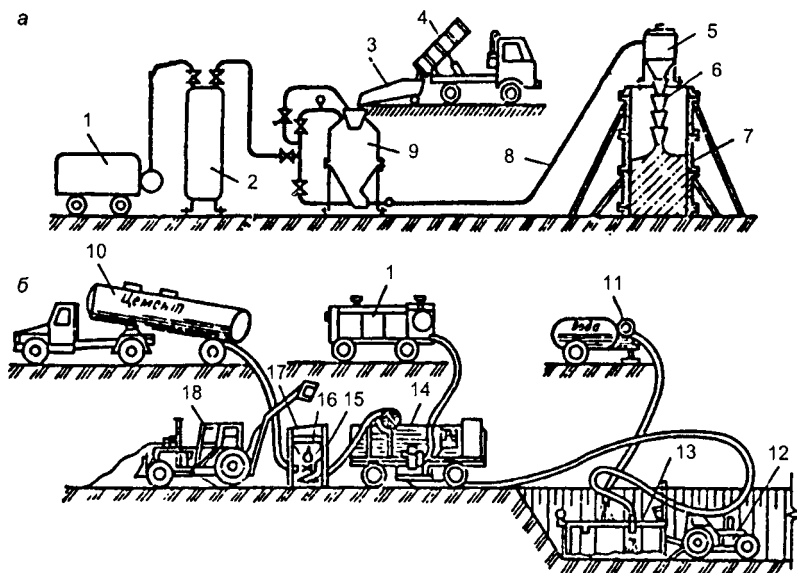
Укладка бетонной смеси пневмонагнетателями:
